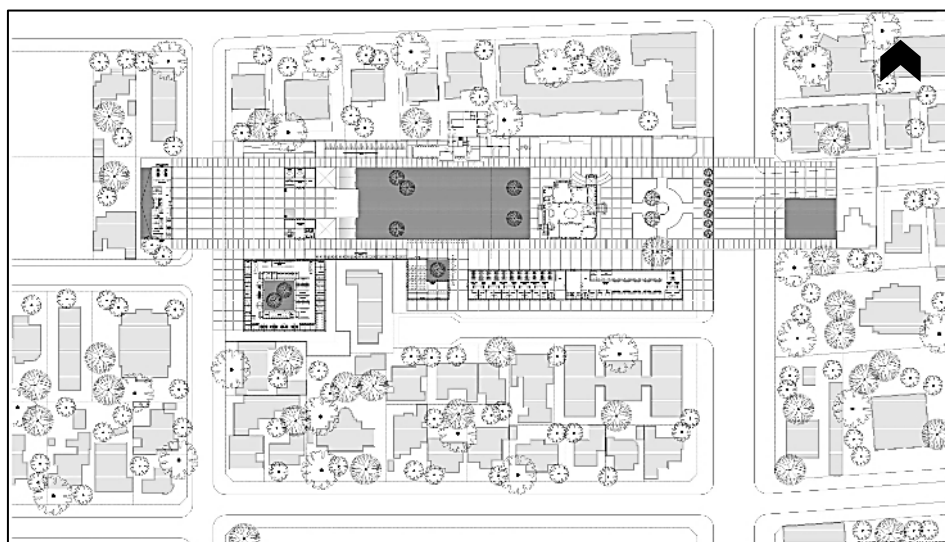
Planta general del Nuevo Edificio Municipal de Providencia
